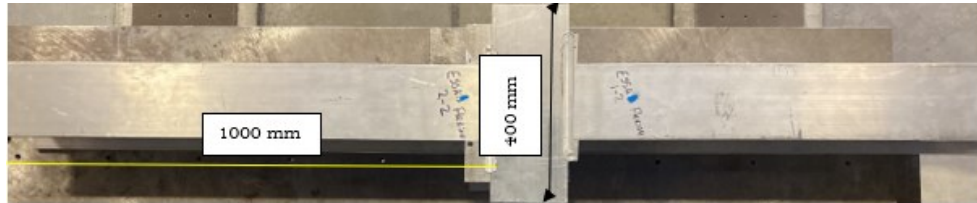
Poutrelle soudée pour essai de flexion.
